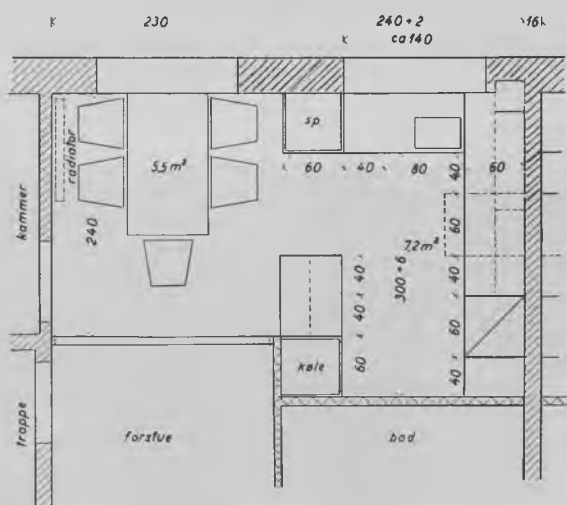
Plan af køkken på 12,7 m<sup>2</sup> (med spiseplads). (Dansk Køkkensæt.)
